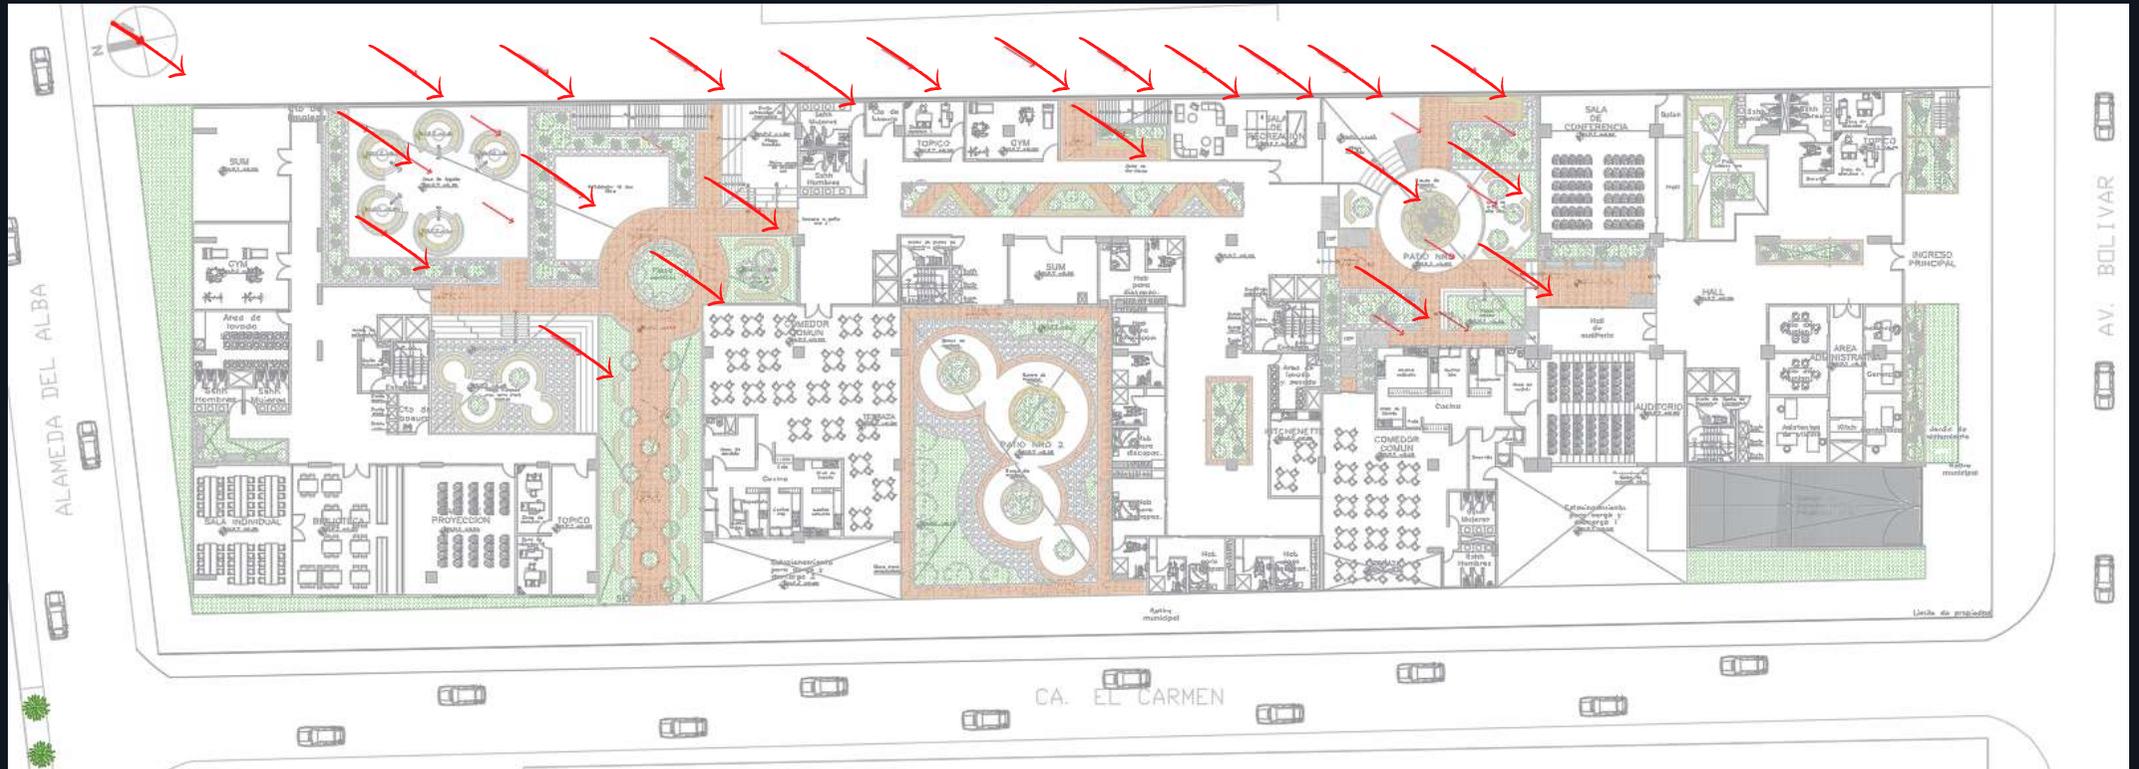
FUENTE: PROPIA. PLANTA PRIMER PISO CON DIRECCION DEL VIENTO
